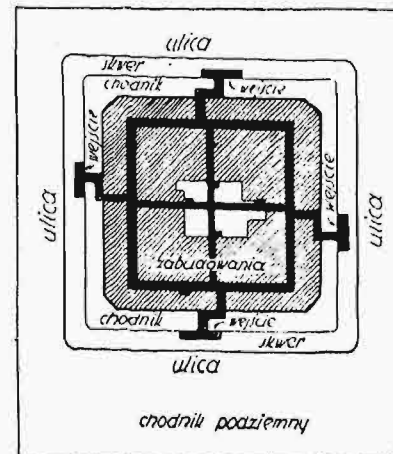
szy przedstawia plan, a rys. 2-gi przekrój takiego schronu.
